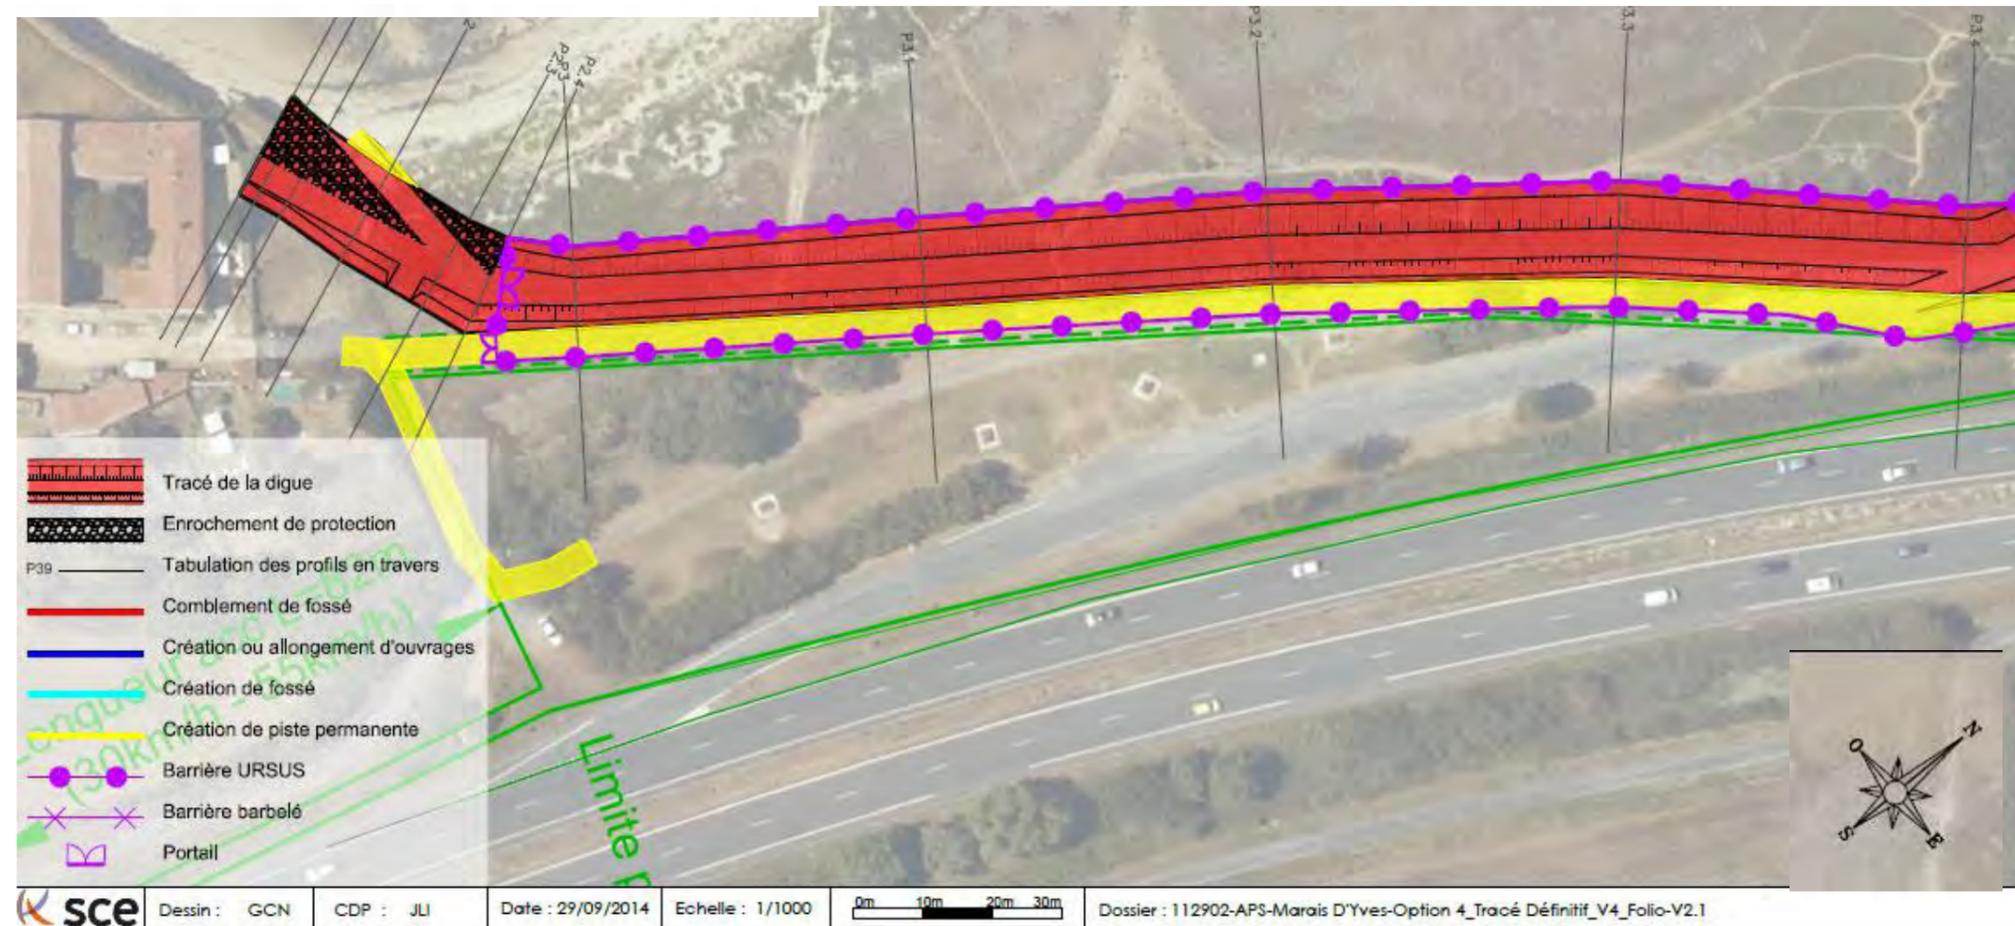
plan AVP - implantation projetée au Sud de la réserve – site Classé.
